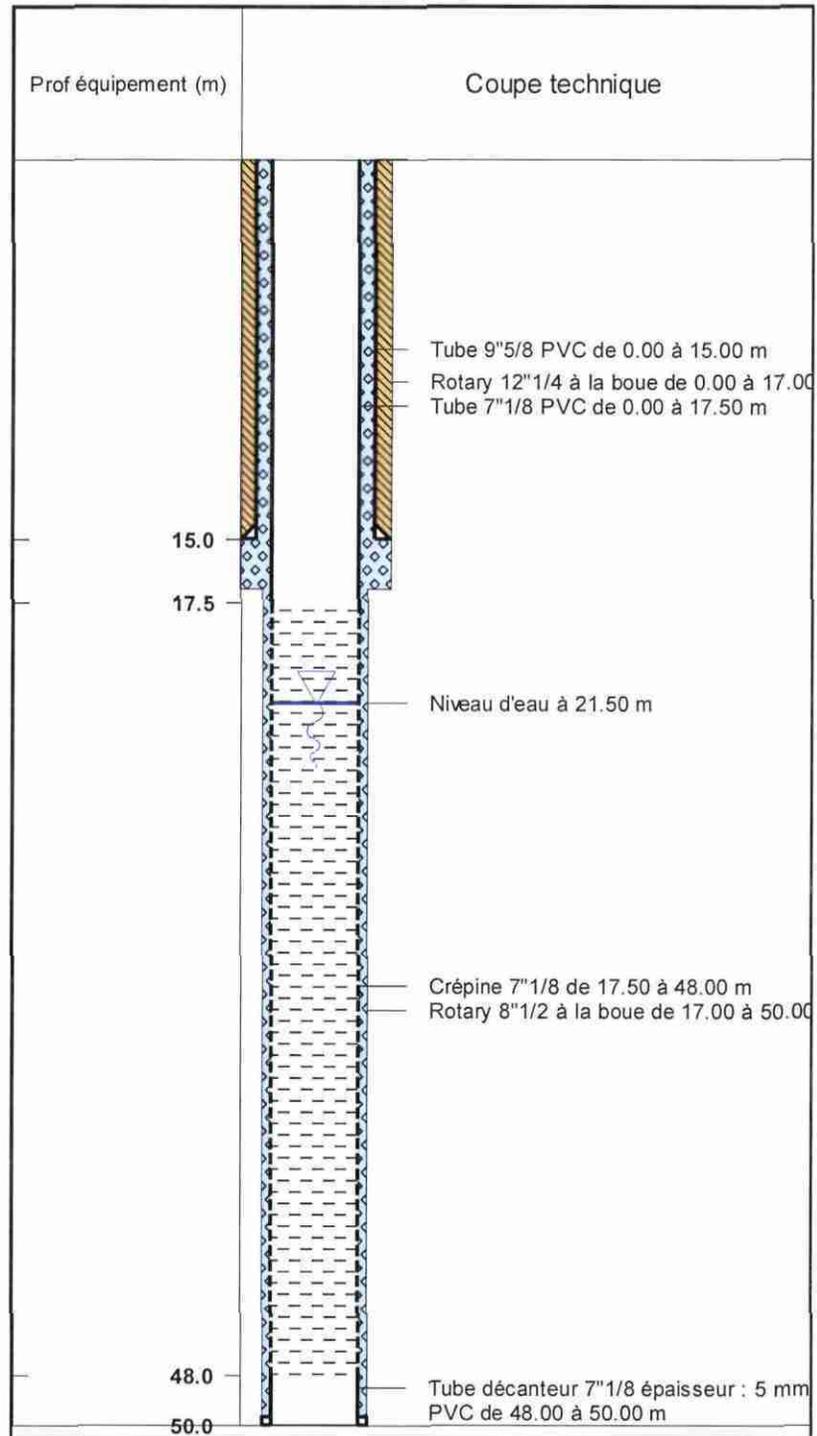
Coupe technique du forage "Moulin d'Augey" à La Brède
